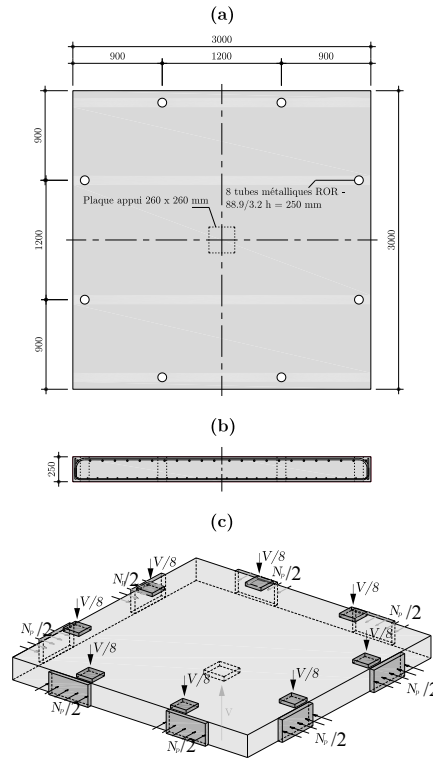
Dimensions des dalles d'essais au poinçonnement chargées par un effort normal de compression: (a) Plan, (b) Coupe et (c) Schéma simplifié du principe de chargement
